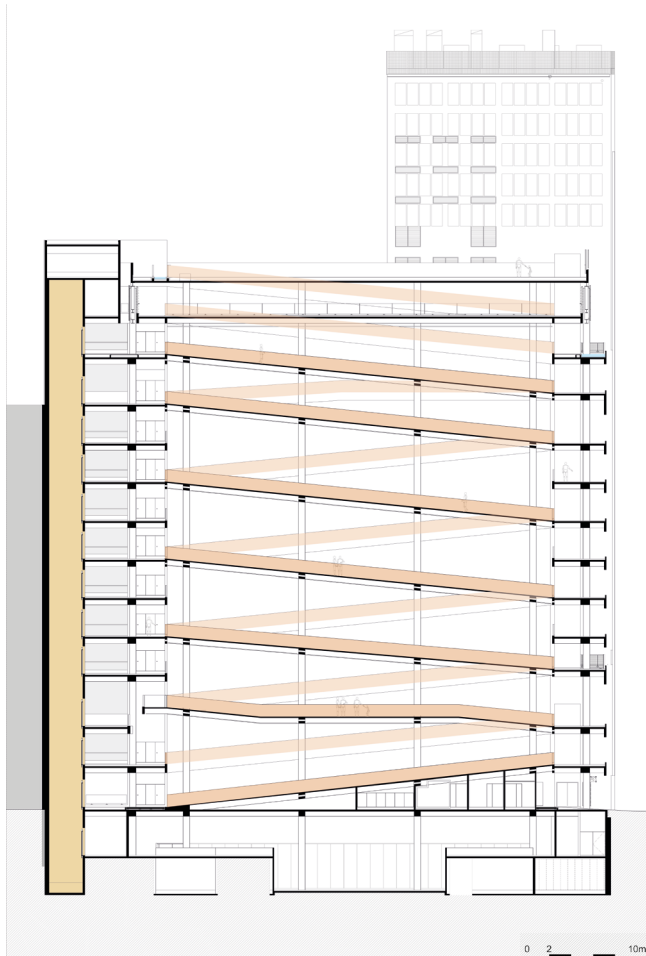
Sección del Sesc 24 de Maio con indicación del sistema de circulación vertical público compuesto por el conjunto de rampas y ascensores. (Autoría propia. 2021. Base: MMBB Arquitetos).
